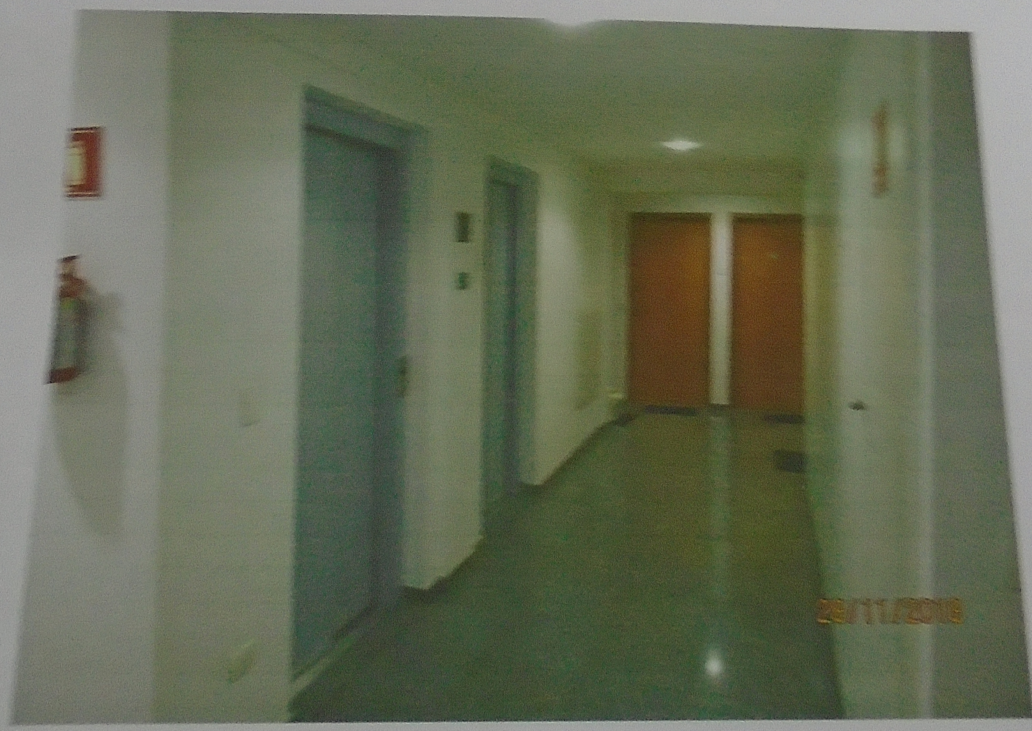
Vista do hall de elevadores no 10º andar do edifício. Observar acabamento de piso, paredes e teto e 02 (dois) elevadores.
